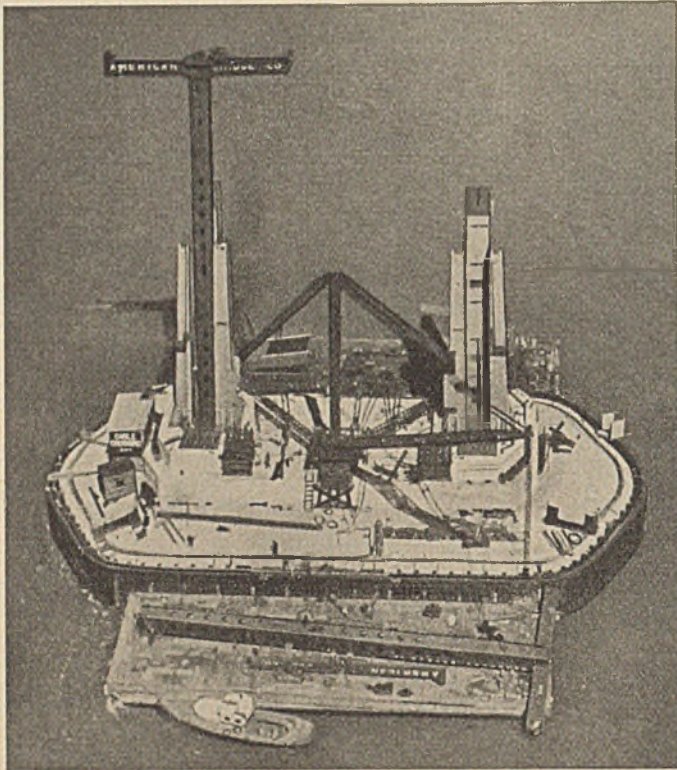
Pylonenfüße mit Hammerkran und Ausladederrick.
